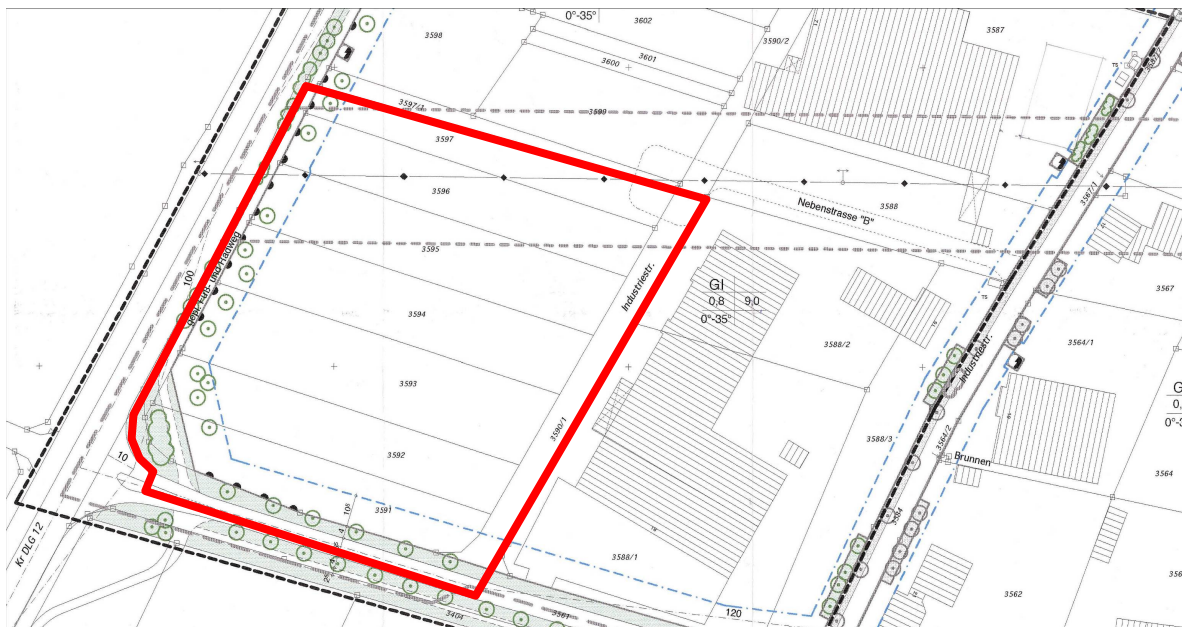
Ausschnitt a.d. rechtskräftigen Bebauungsplan „Industriegebiet Süd II“ 1. Änderung, o.M.
